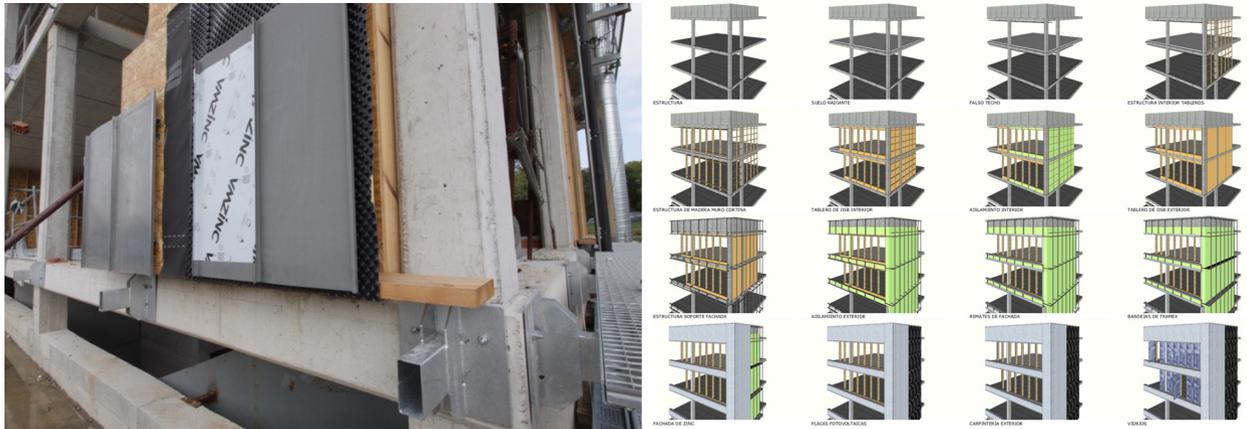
Fotografía ejecución de cerramiento de fachada. Figura 11. Esquema de construcción de cerramiento de fachada.
